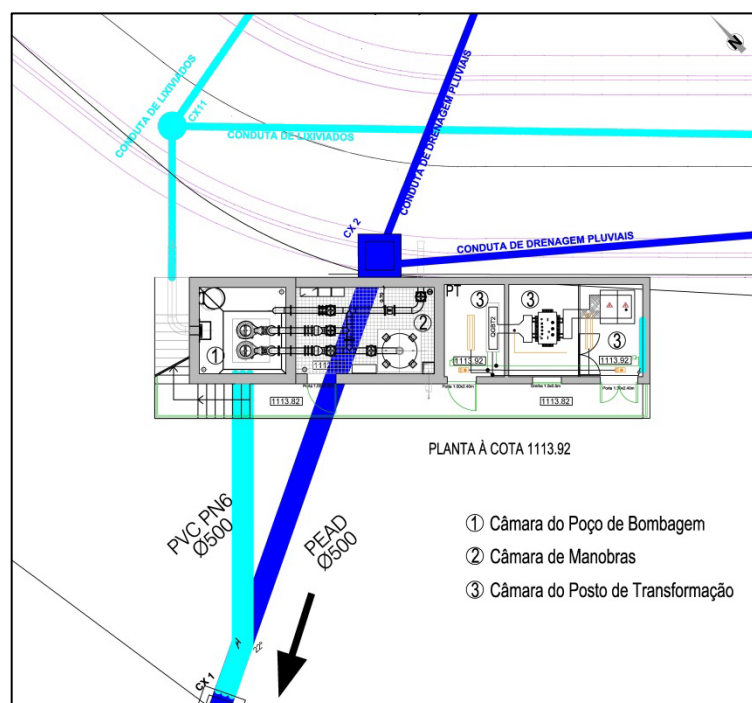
PLANTA DO EDIFÍCIO DA ESTAÇÃO DE ELEVAÇÃO E PORMENORES, (ADAPTADO VALOR AMBIENTE, (2013)).
